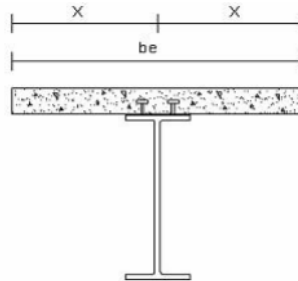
9 Ancho efectivo del tablero en vigas interiores
